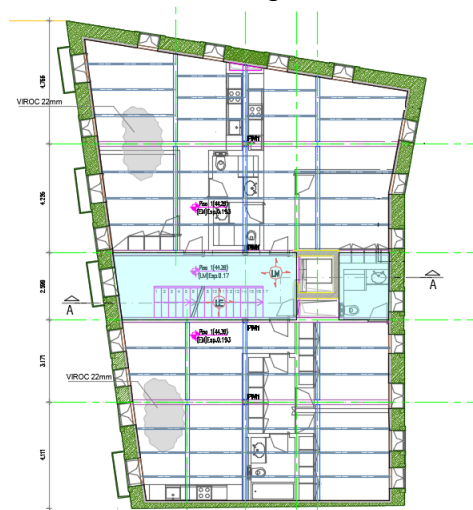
Representação em planta de piso tipo do local onde foram executadas as lajes
